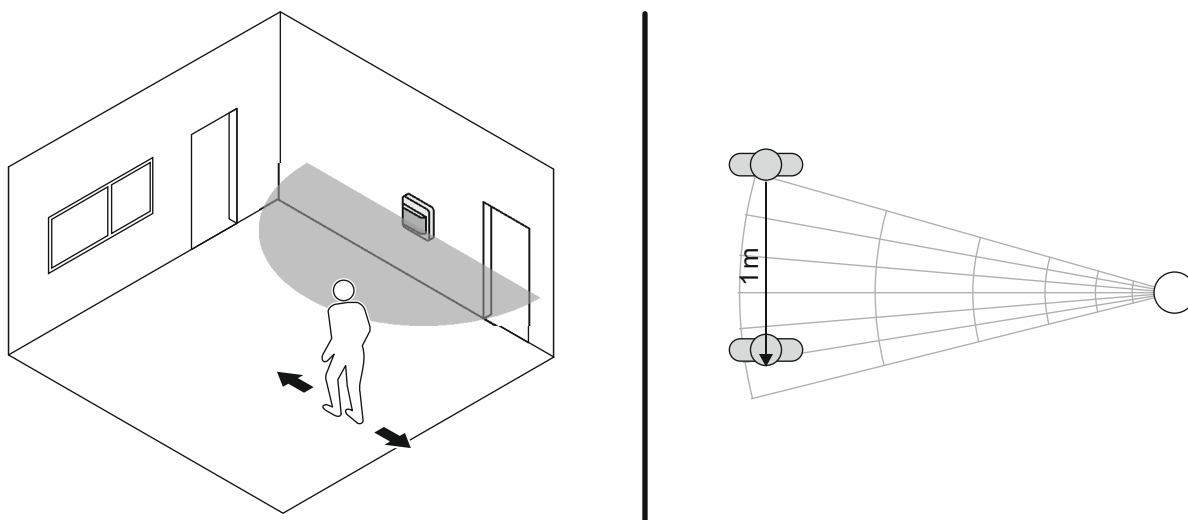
Rilevamento trasversale rispetto all'apparecchio
